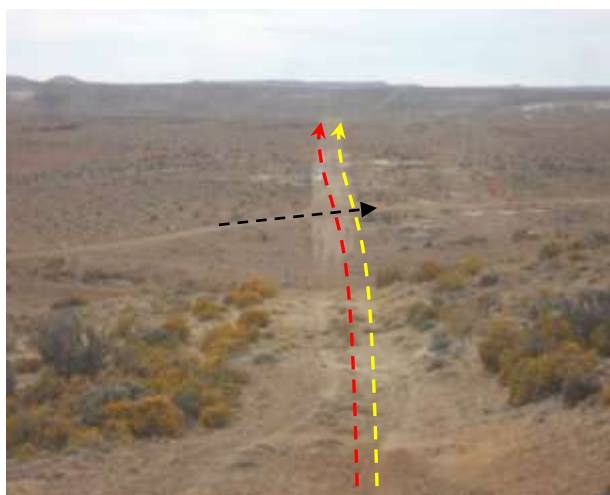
Se observa vista general de la picada por donde se emplazarán los ductos. Cruce con camino principal (negro). Foto en dirección Sur.
